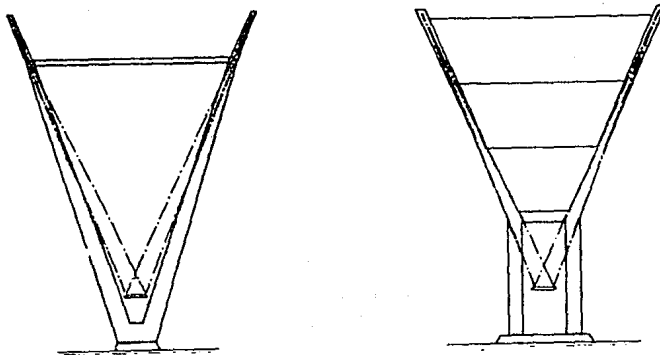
PILONES CON PIES INCLINADOS PARA SOPORTE DE UN SISTEMA DE TIRANTES CON CUATRO PLANOS.
